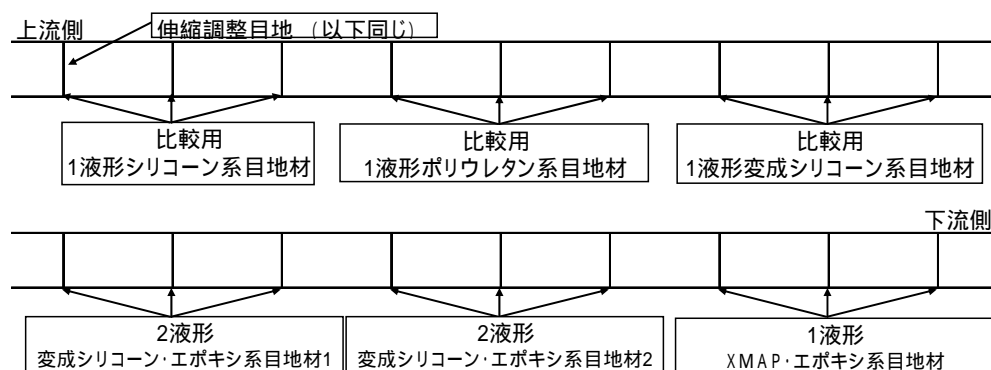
試験施工の平面図（D地区 スパン11m、E地区 スパン9m）
